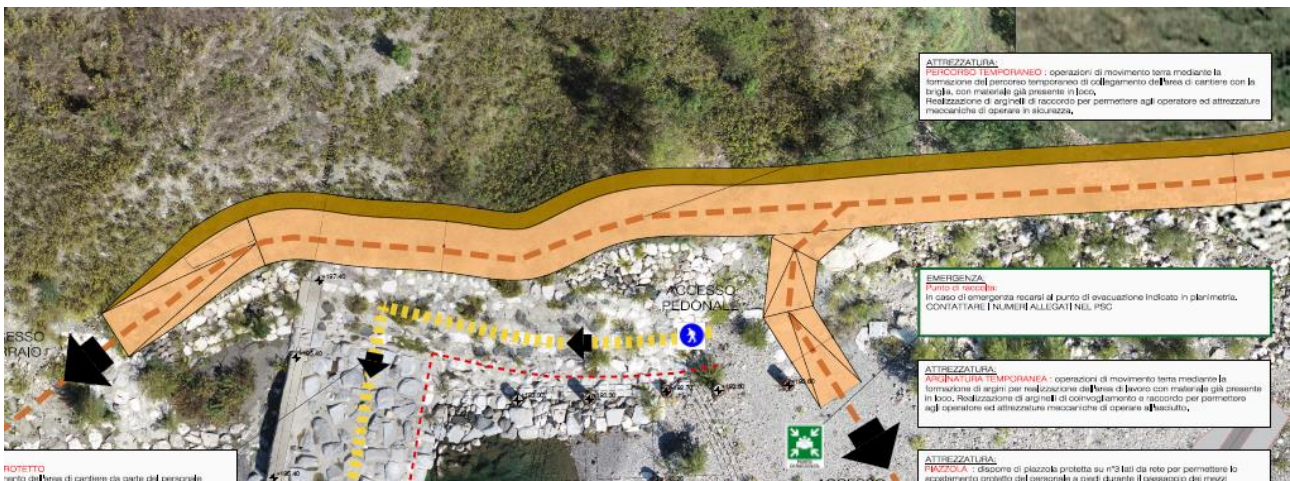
Estratto dell'allegato 7.6.1 Accantieramento e prima fase d'intervento che individua un tratto della nuova porzione di pista di cantiere da realizzare per raggiungere il sito di intervento in sinistra idraulica
